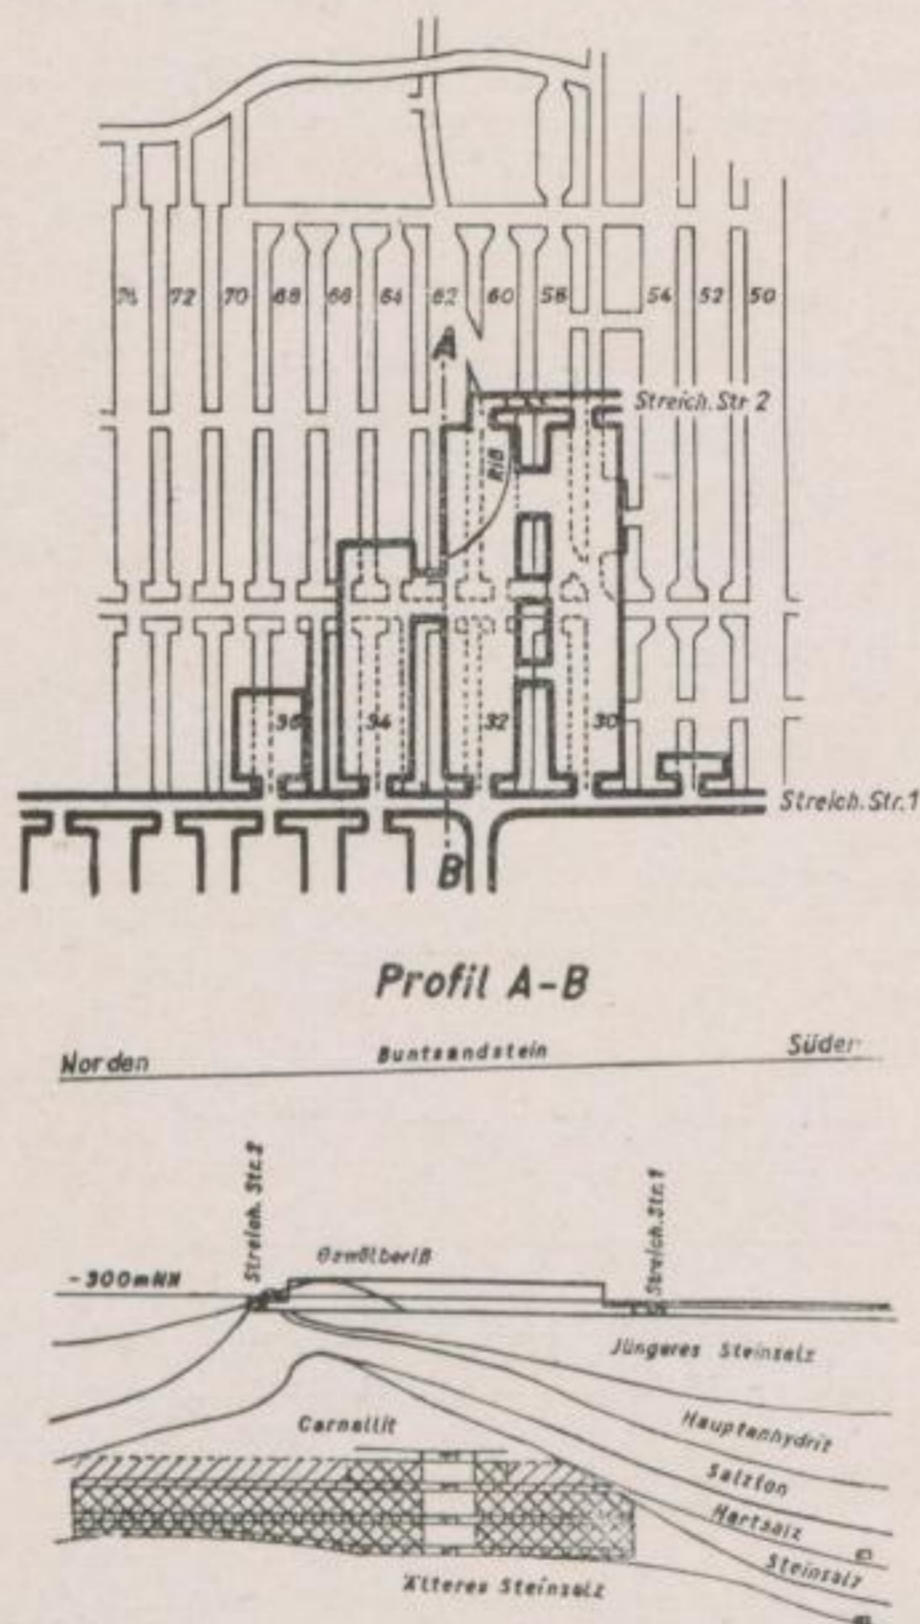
Grundriß und Profil der Baue im Carnallit und jüngeren Steinsalz (letzteres stark ausgezogen) auf der Grube Friedenshall
